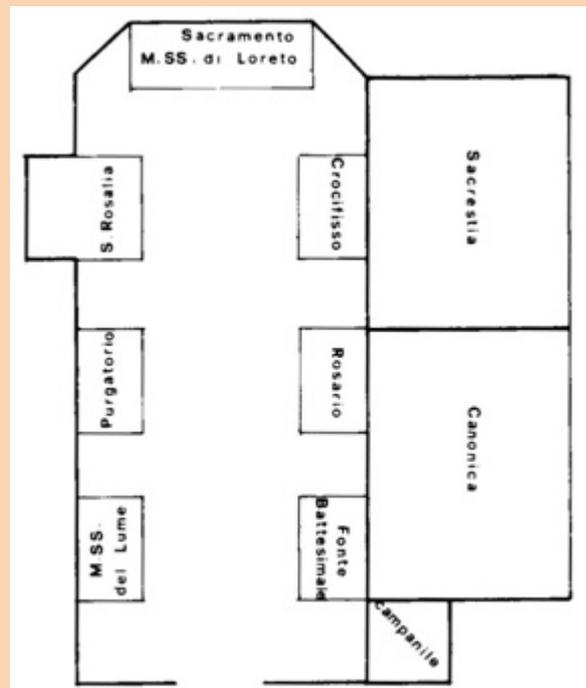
schema planimetrico della chiesa S. Maria di Loreto di Delia al 1749
